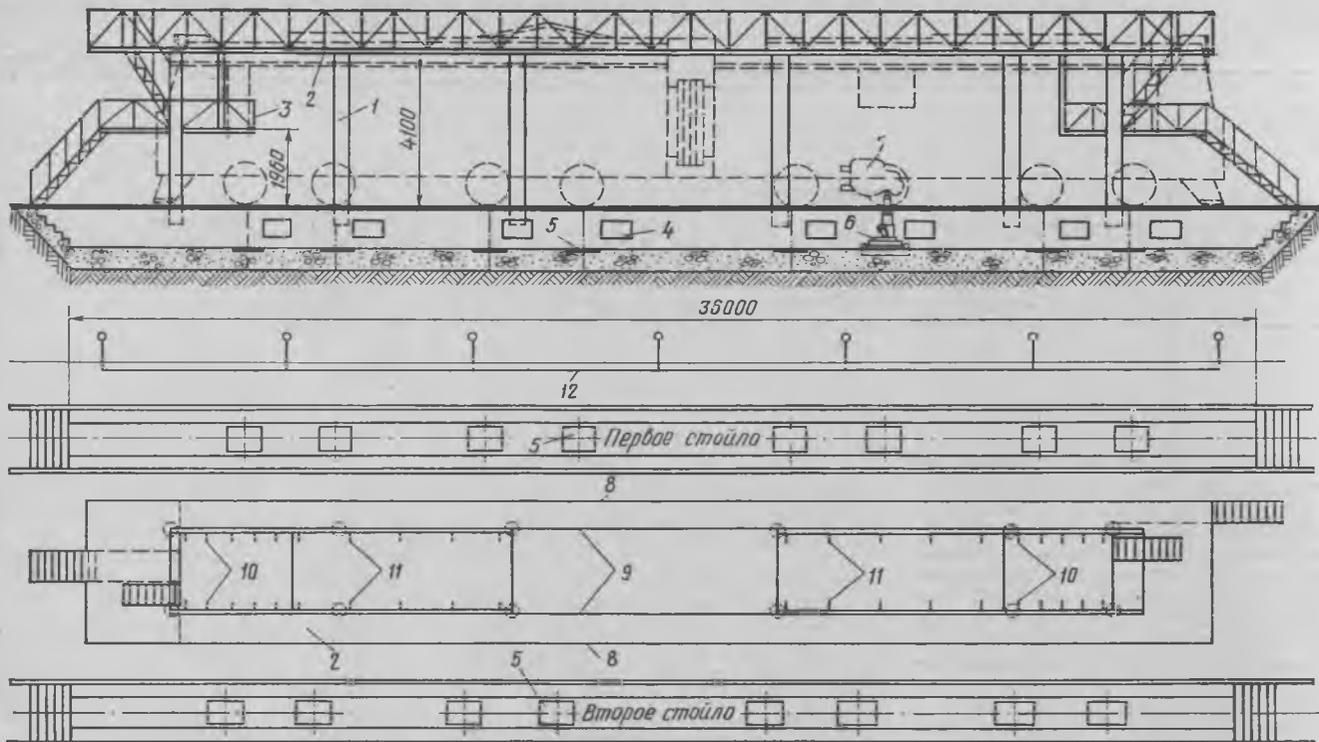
Продольный разрез механизированного стойла и верхней площадки со стойлами в плане:
